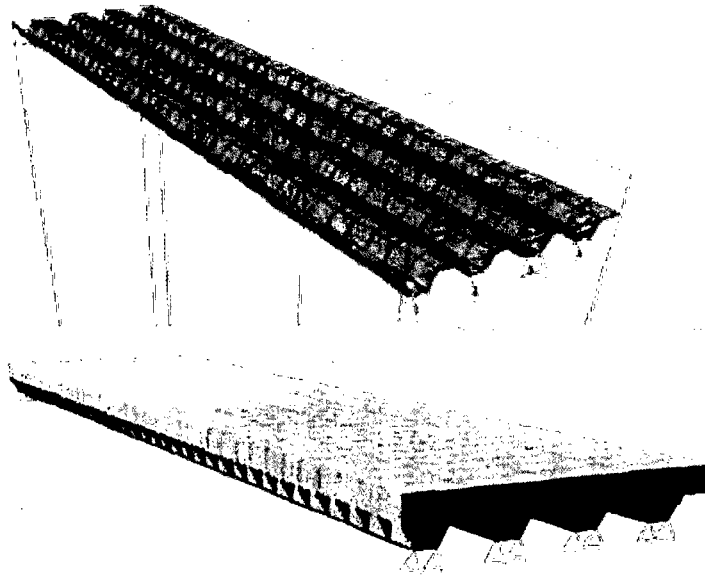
6: Placa AD-600 y losa colaborante (SAP2000).
